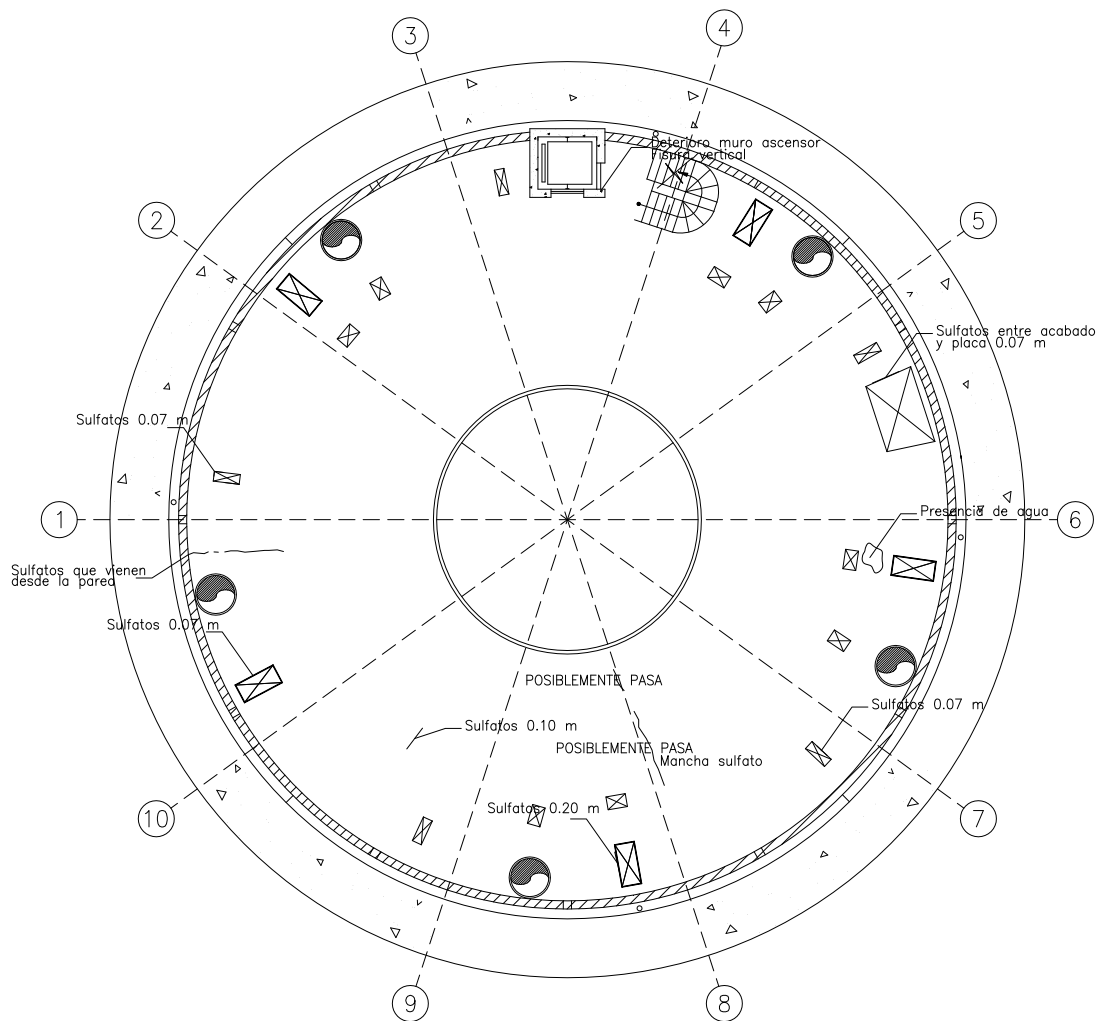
Mapeo de fisuras y eflorescencias cara inferior placa sótano 3 (archivo propio)
